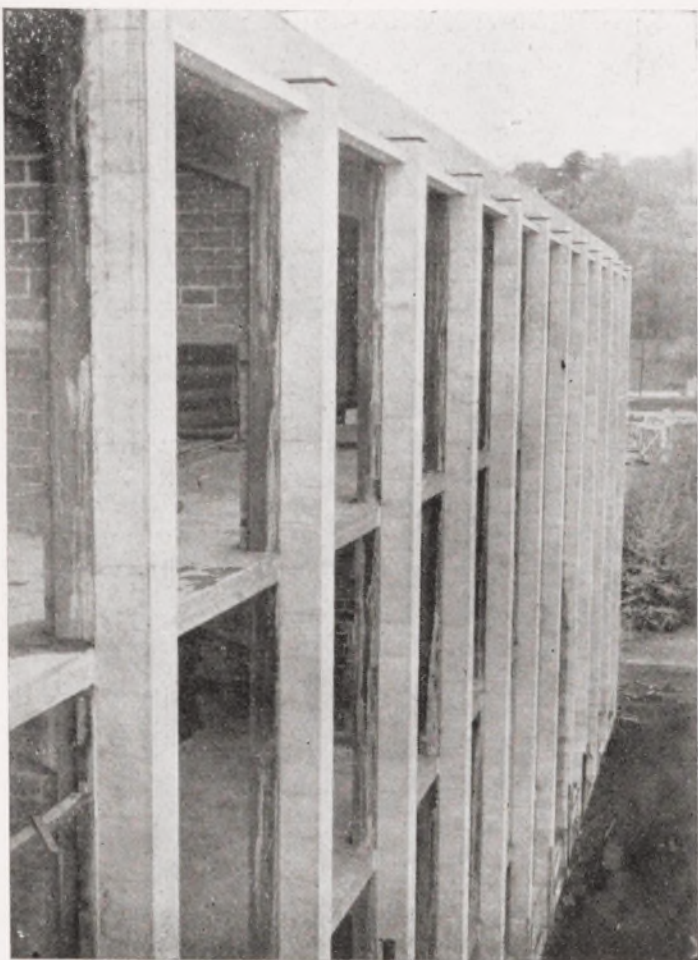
Colonnade en béton blanc de la façade Sud de l'Institut du Génie Civil au Val Benoit (avant sablage).
